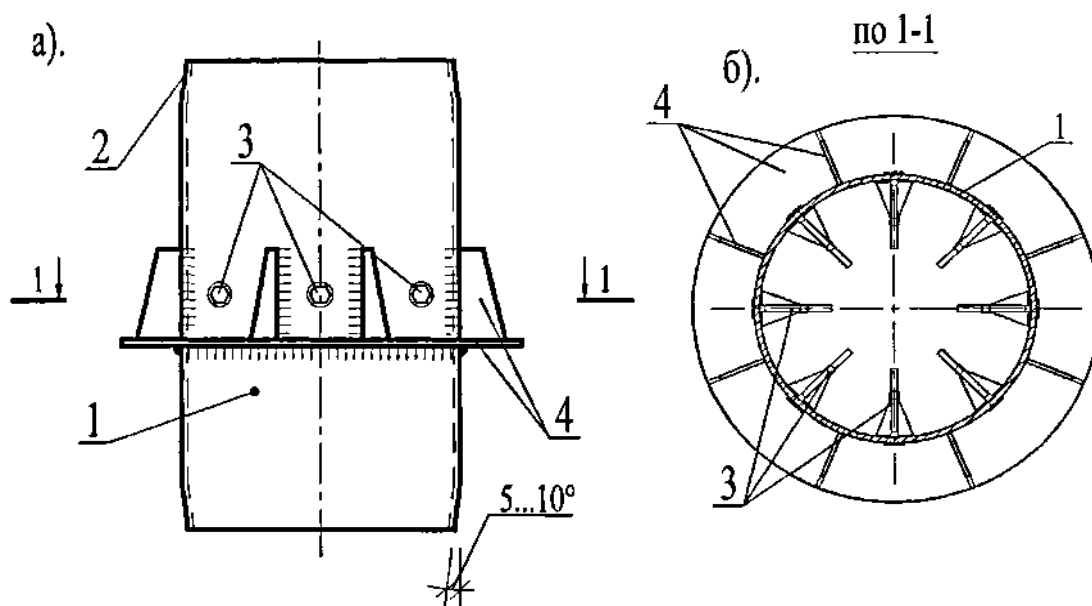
З'єднувальна гільза з циліндричними анкерами
